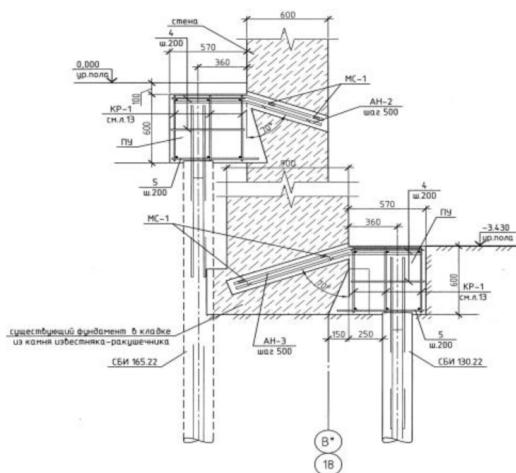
Проектные решения и отдельные этапы выполнения работ по усилению фундаментов здания Гимназии №1
